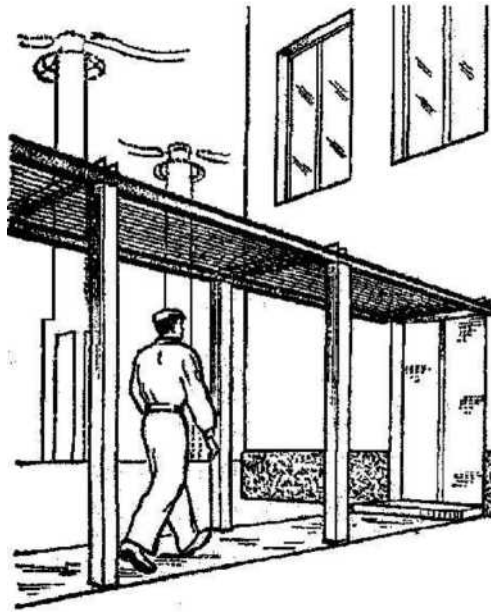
Екрануючі козирки, що перекривають проходи до будівель
